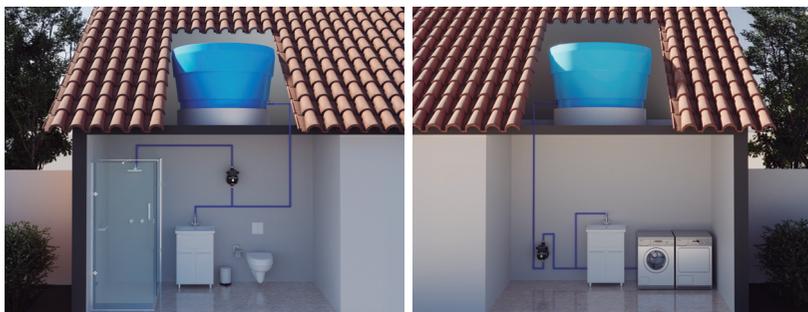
EXEMPLOS DE INSTALAÇÃO DA BOMBA PRESSURIZADORA
